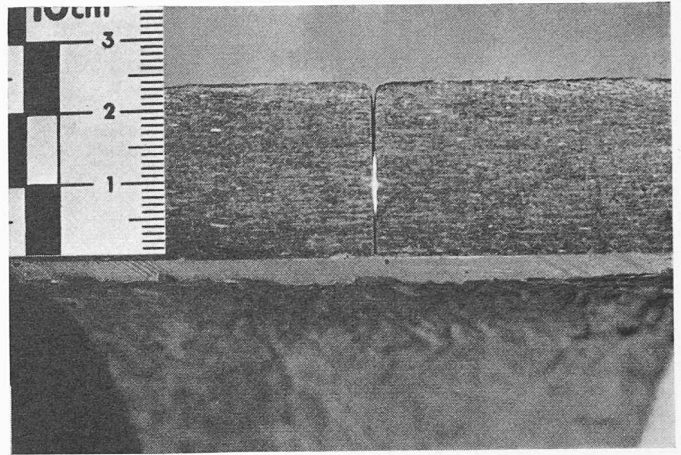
(rechts aussen). Spreizung durch Eisenkeile für Schlitzdruckversuch mit gerecktem Belag
